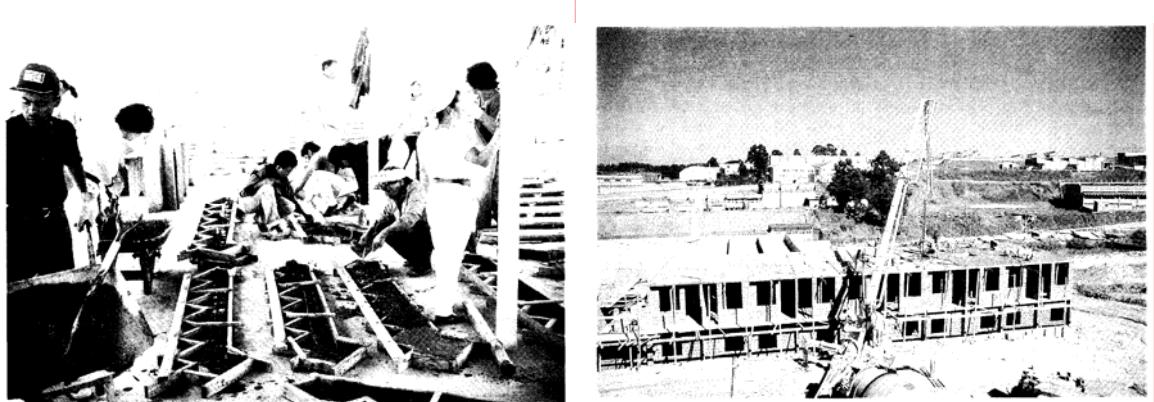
Pré-fabricação de componentes produzidos em mutirão: racionalização da construção reduzindo custo. Autogestão garante alta produtividade: concreto lançado diretamente na laje concretada em mutirão (Fonte: BONDUKI, 1996).
